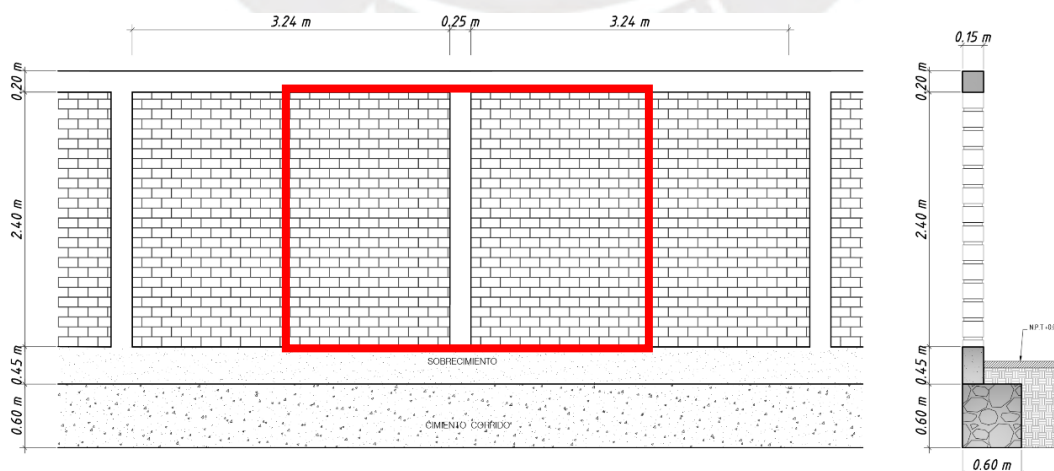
Vista en elevación y corte de muro perimétrico
